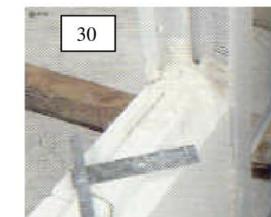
Detalhe da lingüeta metálica em forma de “T” para fixação em portas metálicas
